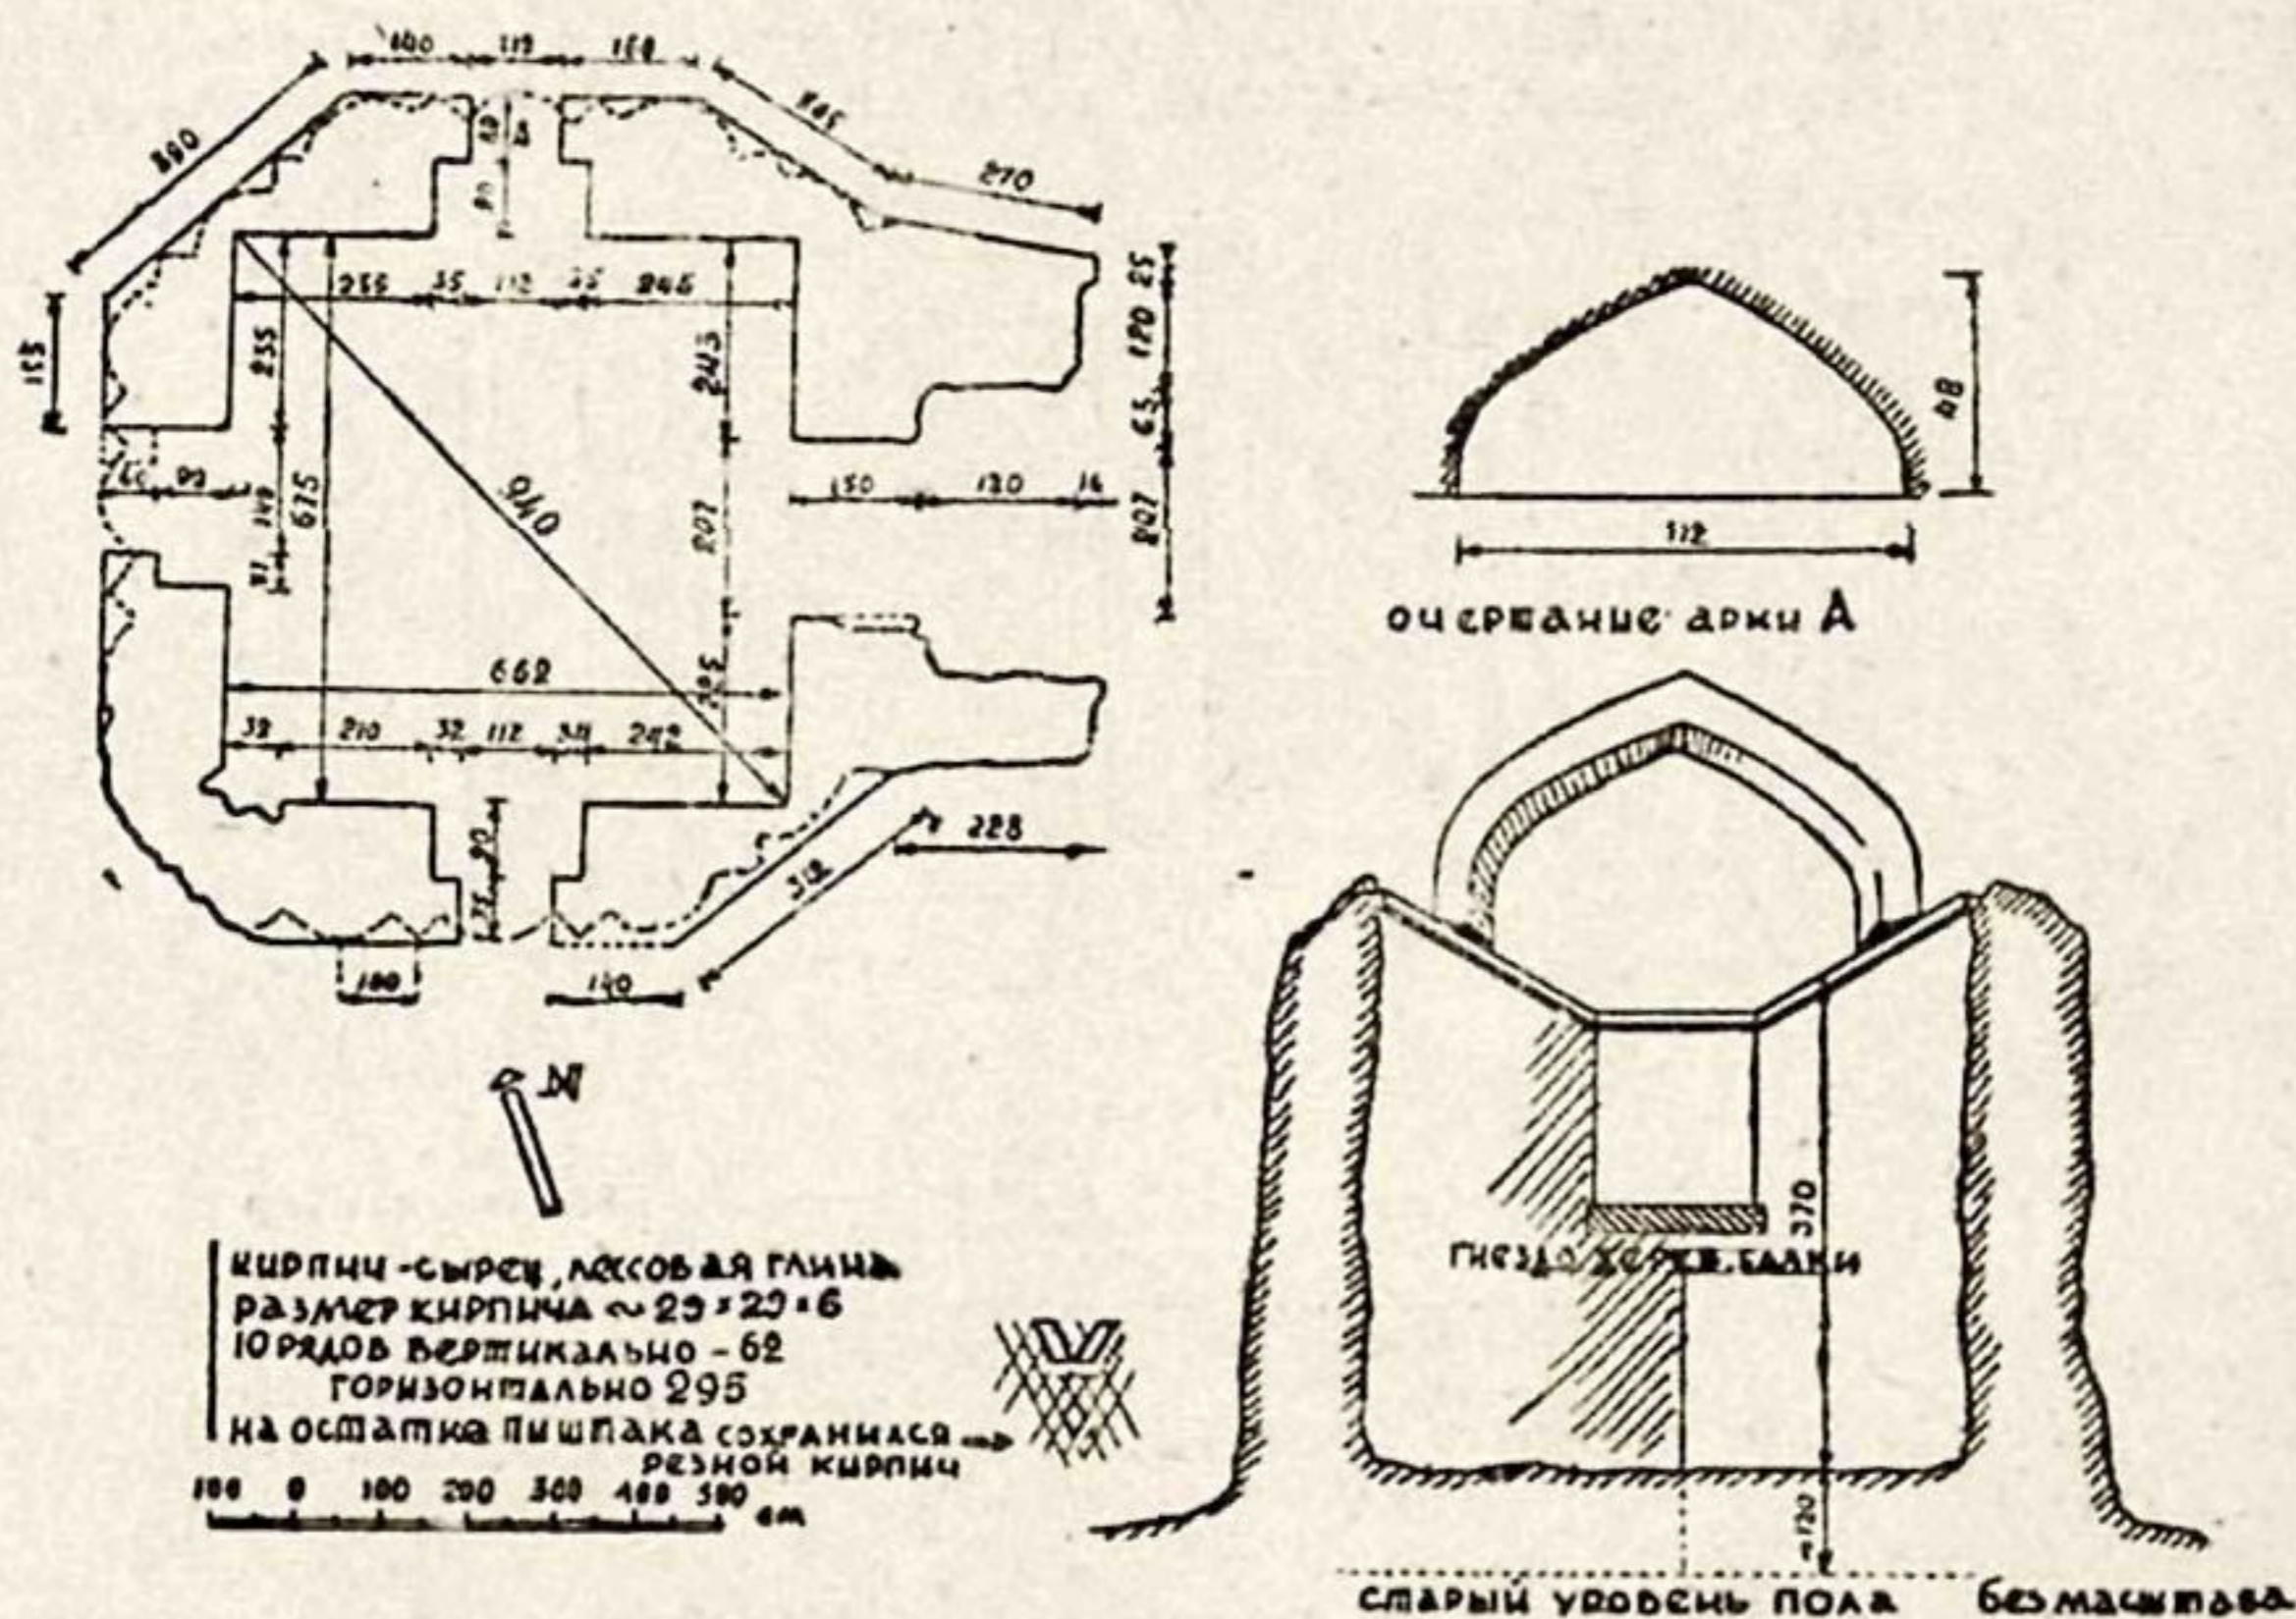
План сырцового здания № 16; оформление угла внутри здания.
